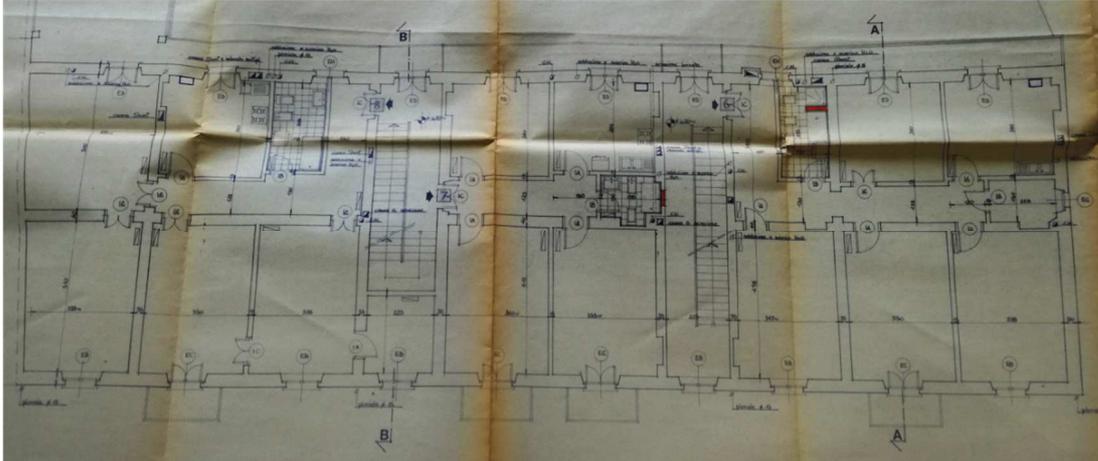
Pianta piano tipo edificio residenziale in via Roma 8/10
